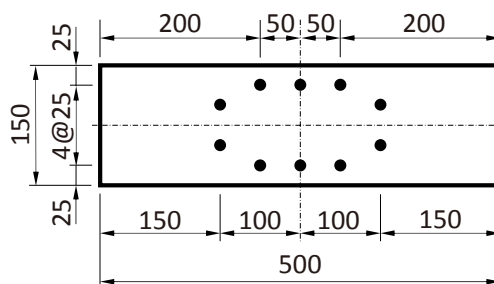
コンクリート表面の膨張率の測定位置 (片側面にゲージの標点を設置)
